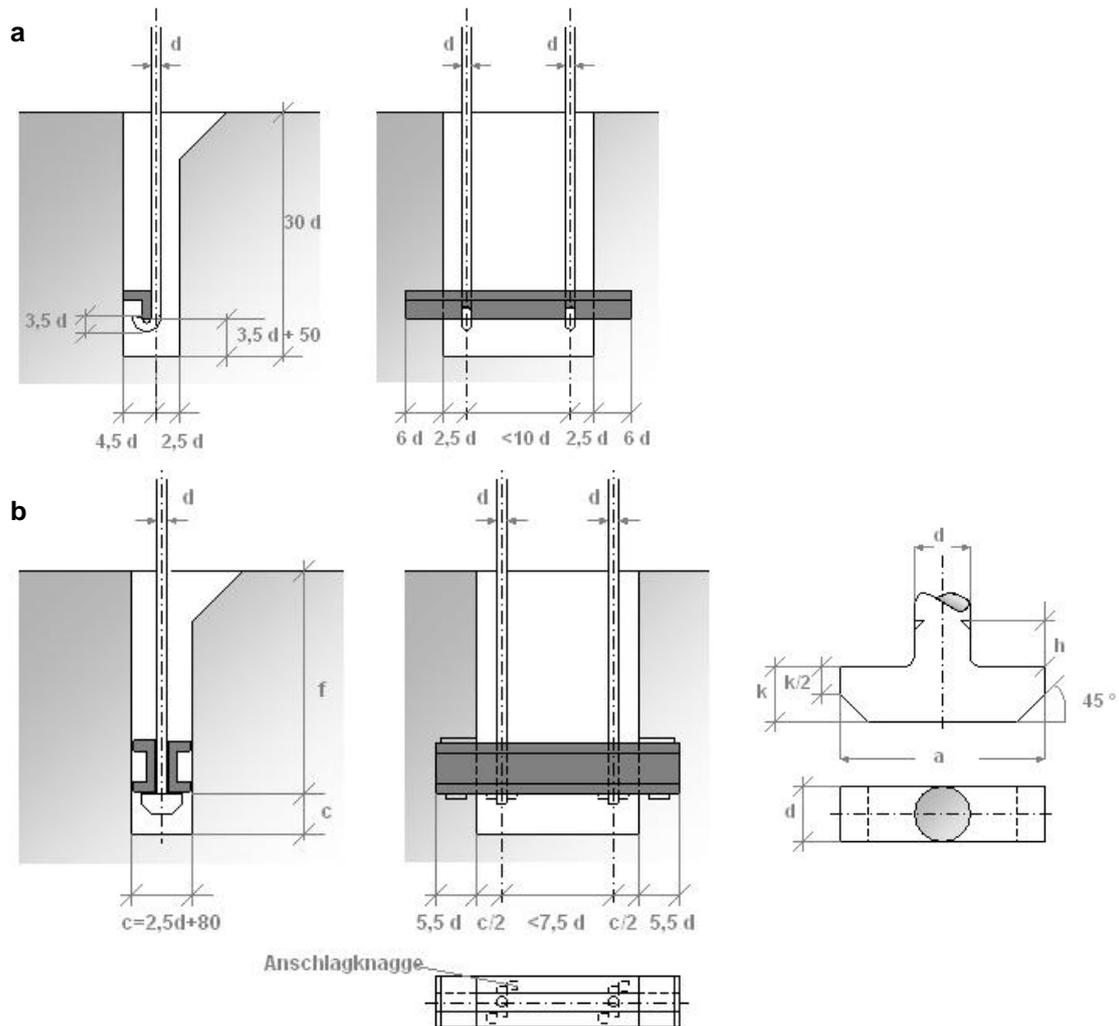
Lösungen zur Rückverankerung der Fußpunkte im Fundament
